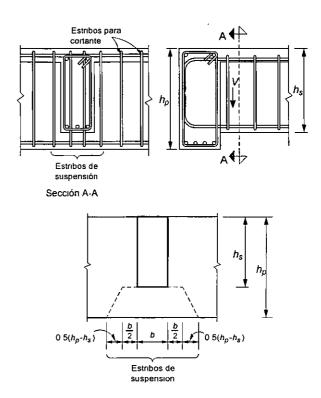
Transmisión de fuerzas y conexión entre vigas secundarias y principales
